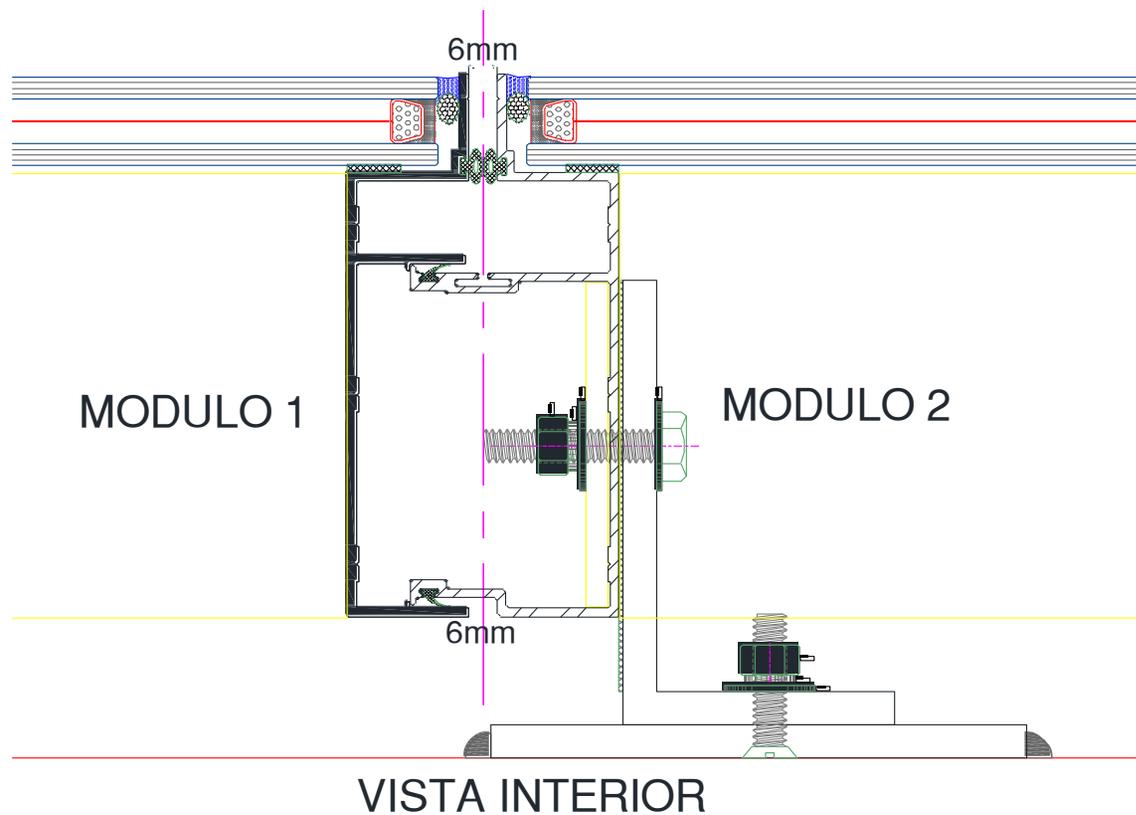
Archivo de autoría propia Earc espacio arquitectónico S.A de C.V 2015
